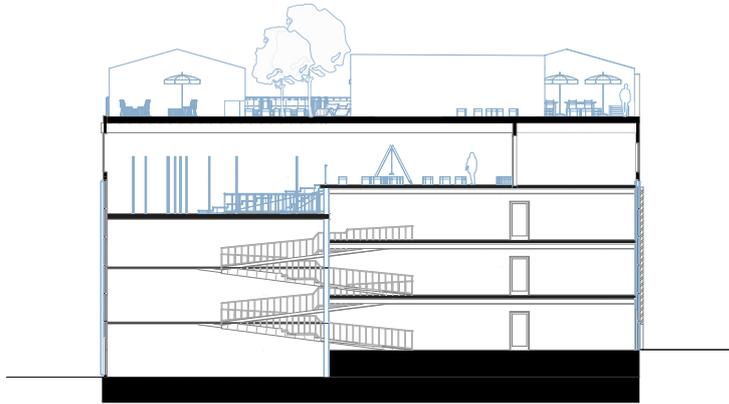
Parkhaus Migerkastraße: Schnitt - M 1:400
